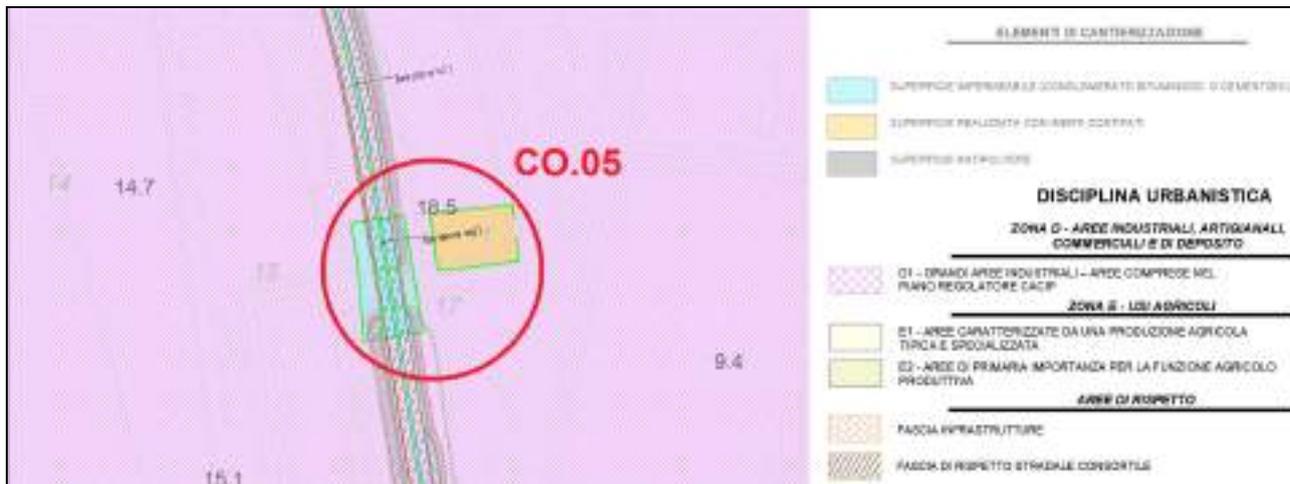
Sovrapposizione del tracciato e delle aree di cantiere operativo-stoccaggio sulla perimetrazione urbanistica – Cantiere Operativo CO.05.
